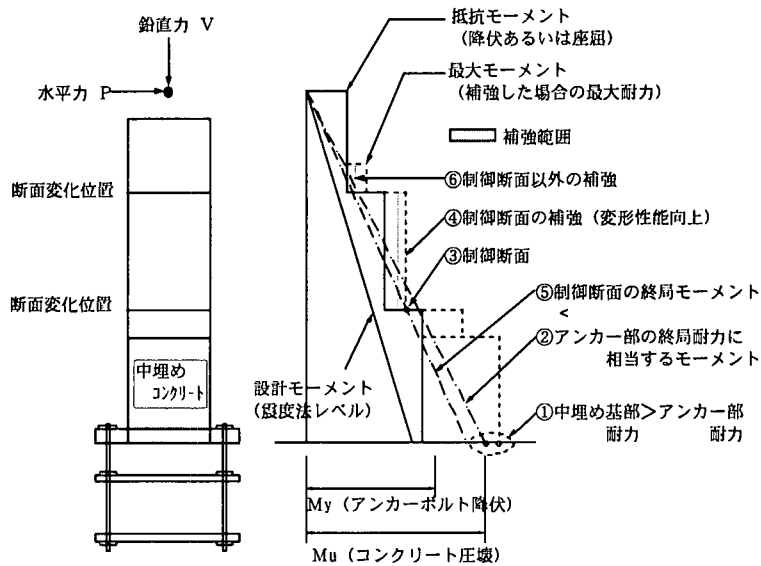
補強設計概念図（鋼断面の断面変化部を制御断面とする場合）
